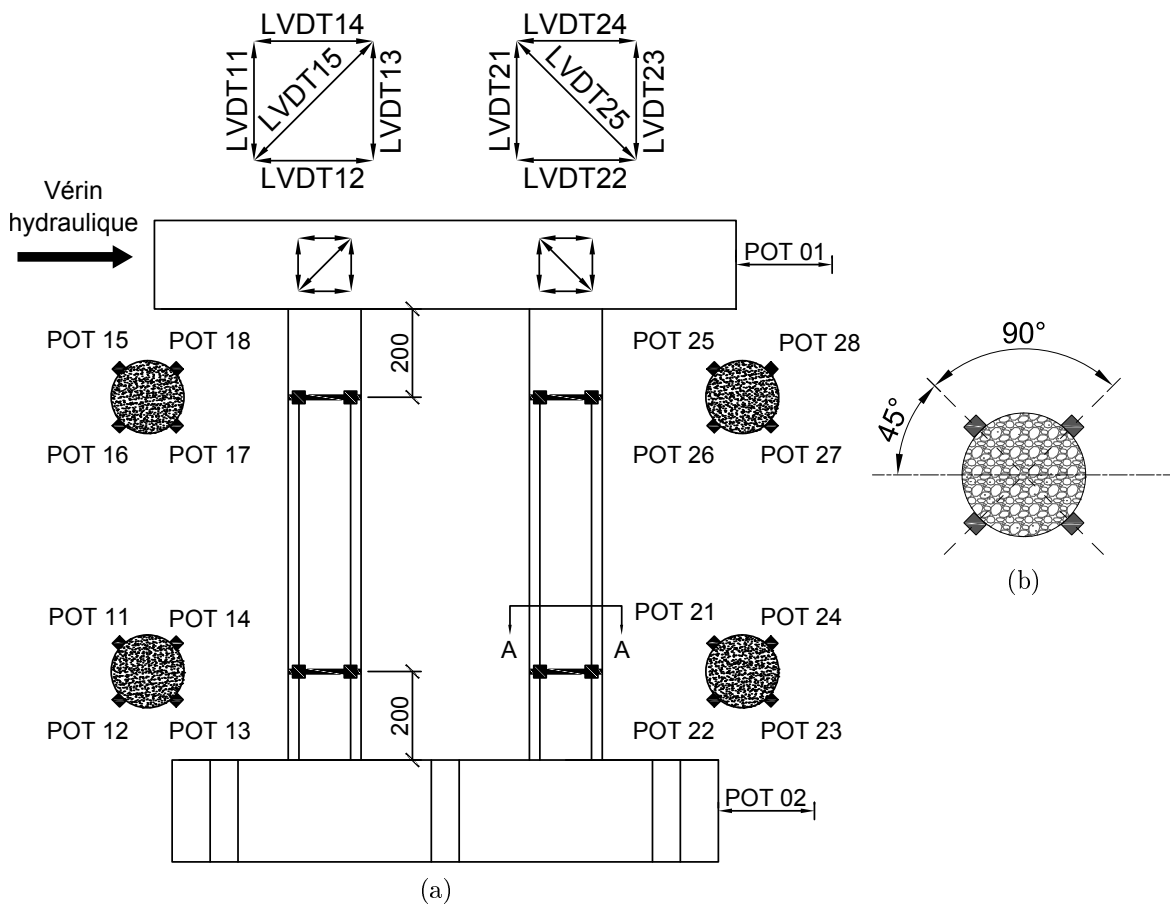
Instrumentation externe de la pile 01 : (a) vue en élévation de la pile 01, (b) coupe A-A : potentiomètres des anneaux
